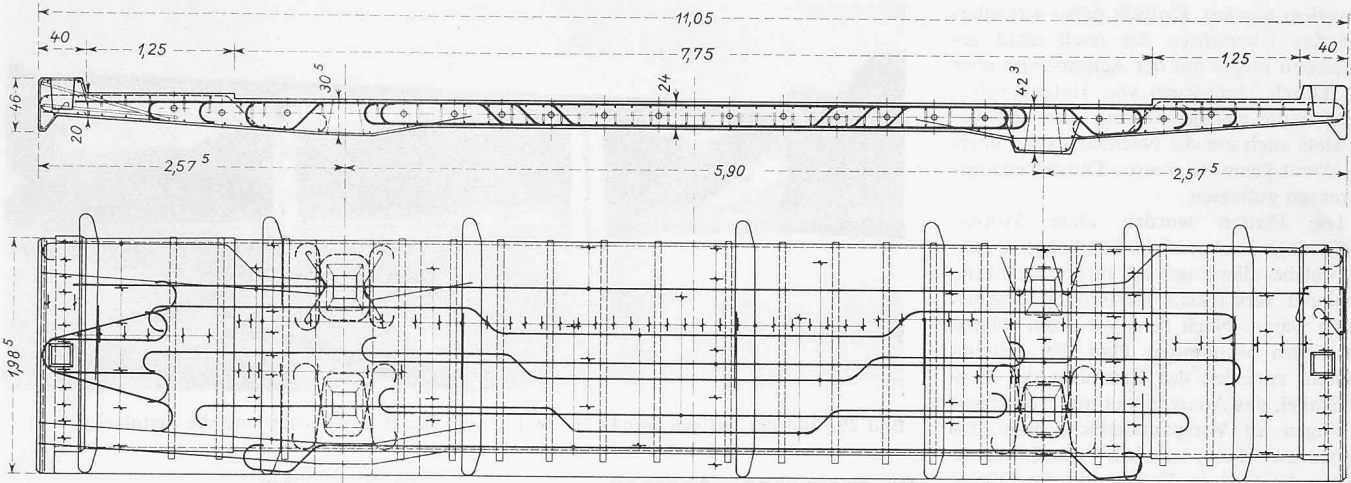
Vorfabrizierte Fahrbahnplatten, Schnitt und Grundriss mit Armierungen und Hüllrohren für die Vorspannung. Masstab 1:65
